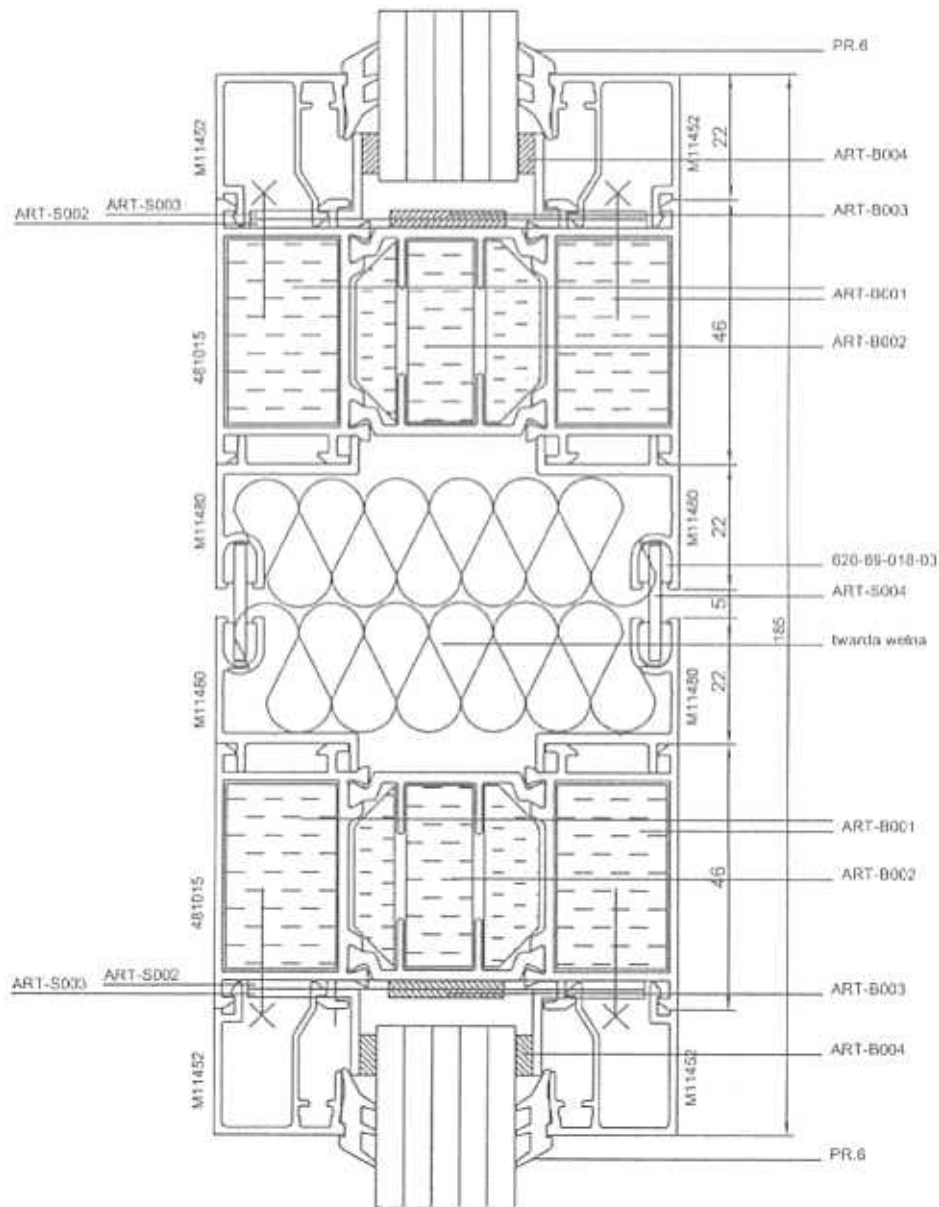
Przekrój 7-7 segmentu ścian wewnętrznych odmian ALUFIRE EI 45 i ALUFIRE EI 60 (przekrój przez element pionowy ramy)
